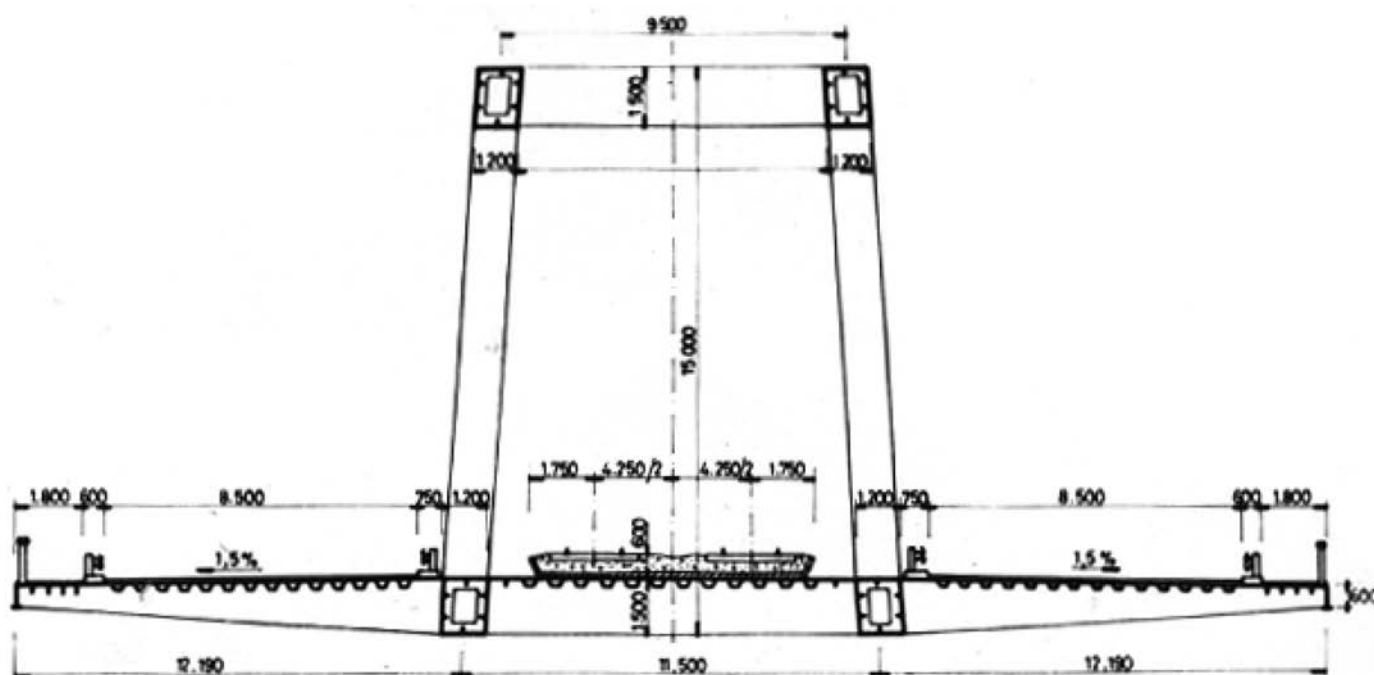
Pod peste Dunăre la km 173, Șantier Naval Brăila. Secțiune transversală supradenivelare
